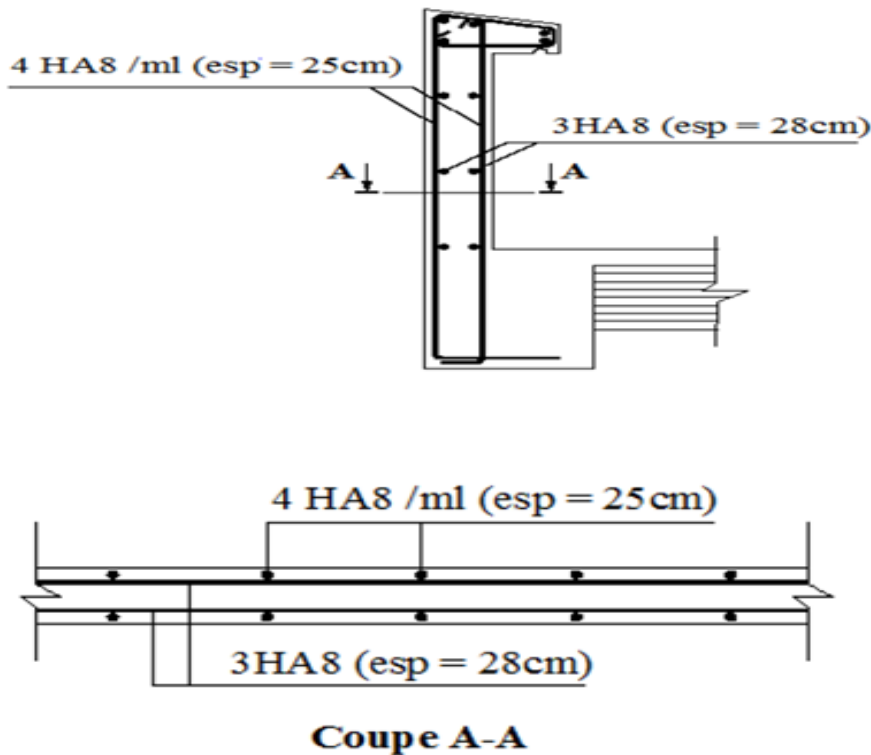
Plan de ferrailage de l'acrotère.
